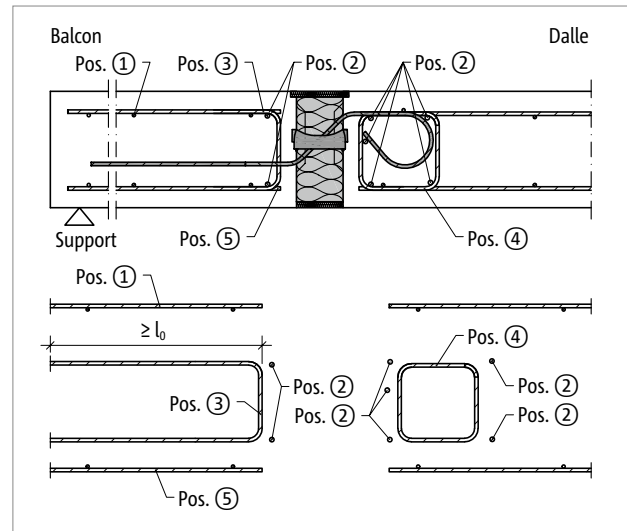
Schöck Isokorb® T Type Q-E-W-V : Renforcement sur site
